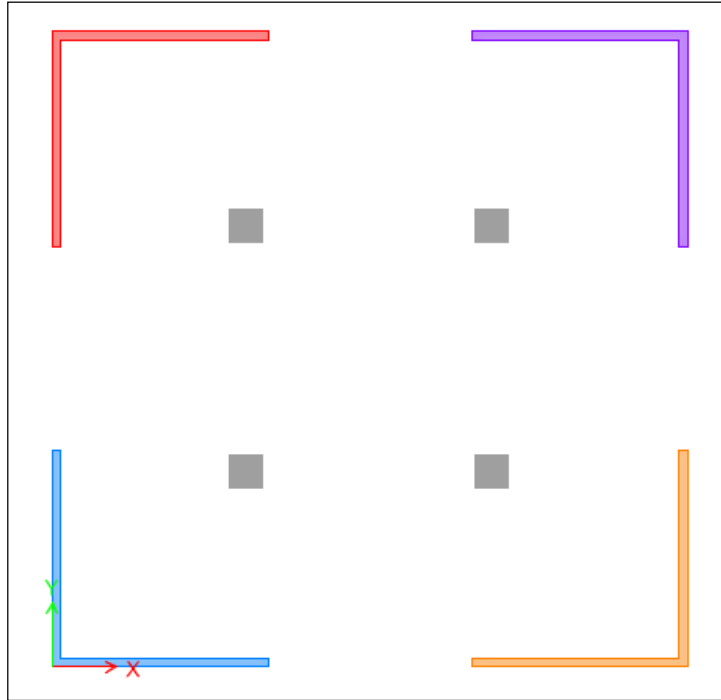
Vista en planta del Edificio D (elementos tipo barra de sección transversal irregular)
